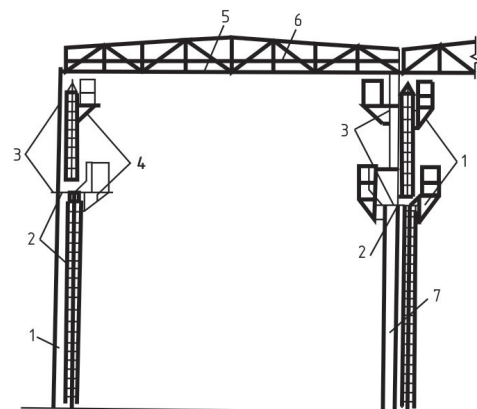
Размещение люлек и лестниц на конструкциях здания.
